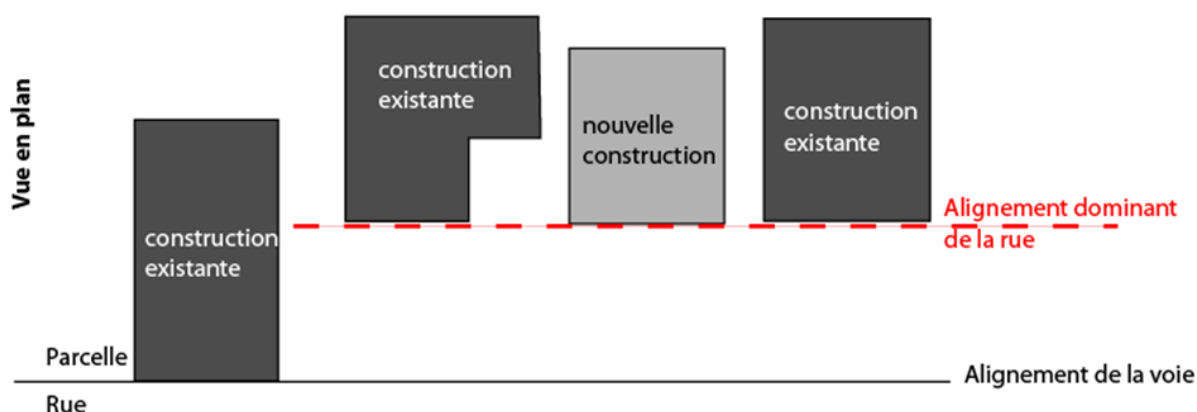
Implantation par rapport aux voies et emprise publique – pour les nouvelles constructions
